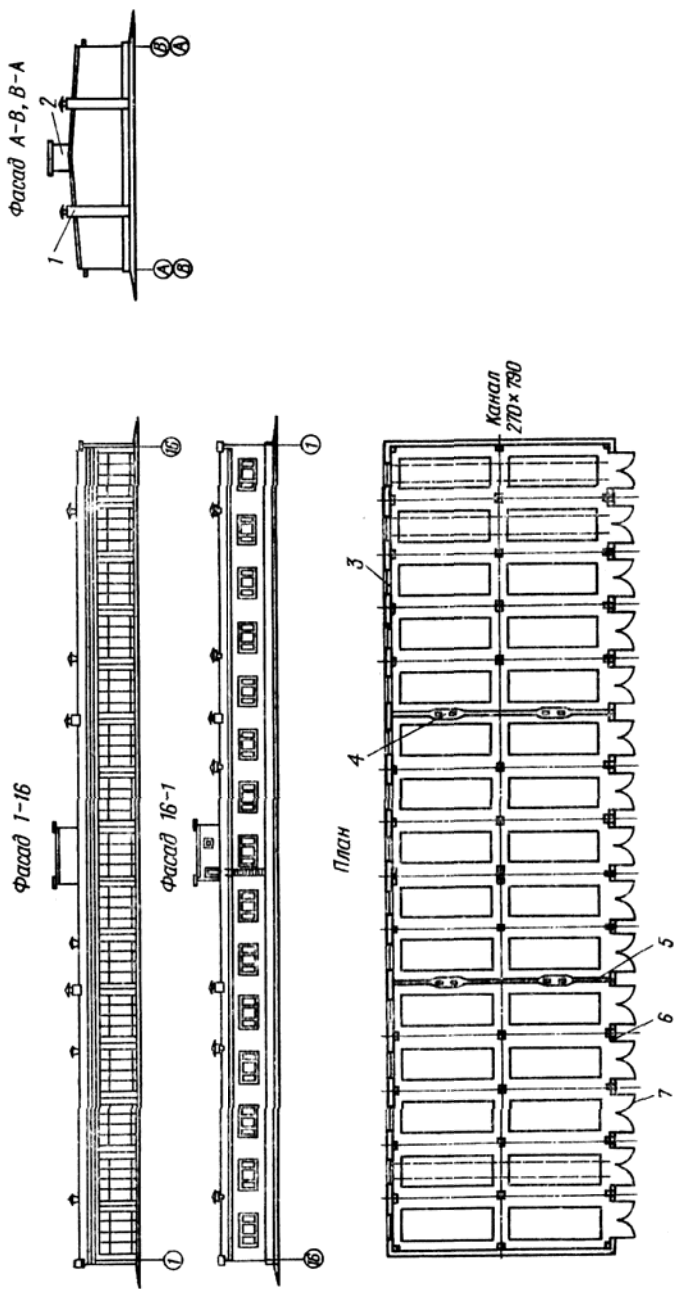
План и фасады отапливаемого хранилища на 30 машин:
